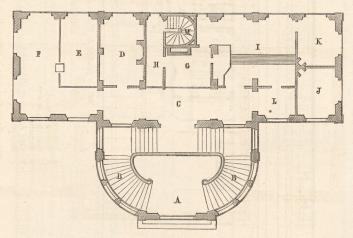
Station de Chelles. Rez-de-chaussée.
